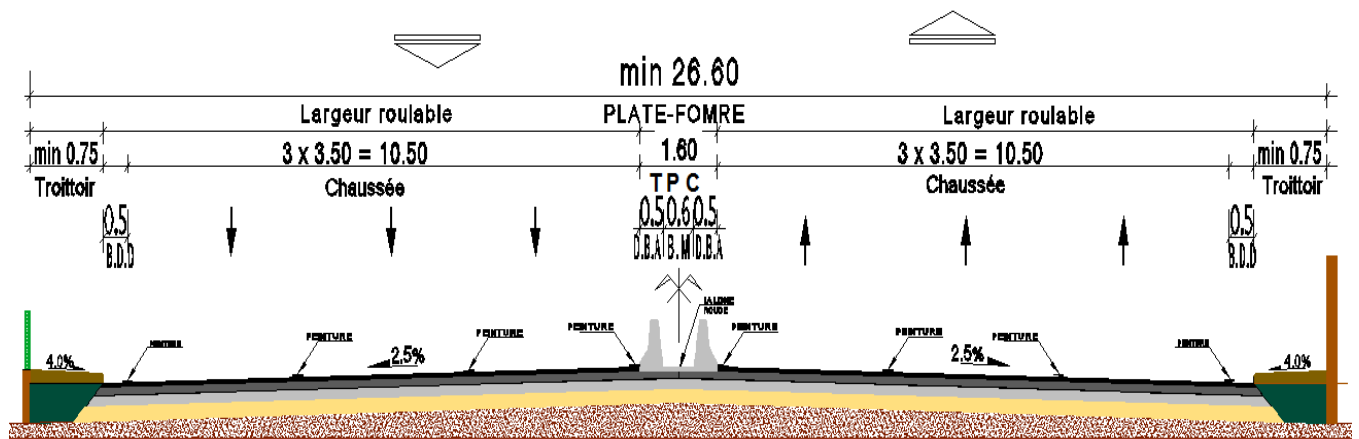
Profil en travers de la section en 2 x 3 voies
